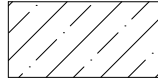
SEVERNÍ STRANA ZÁKLADŮ
